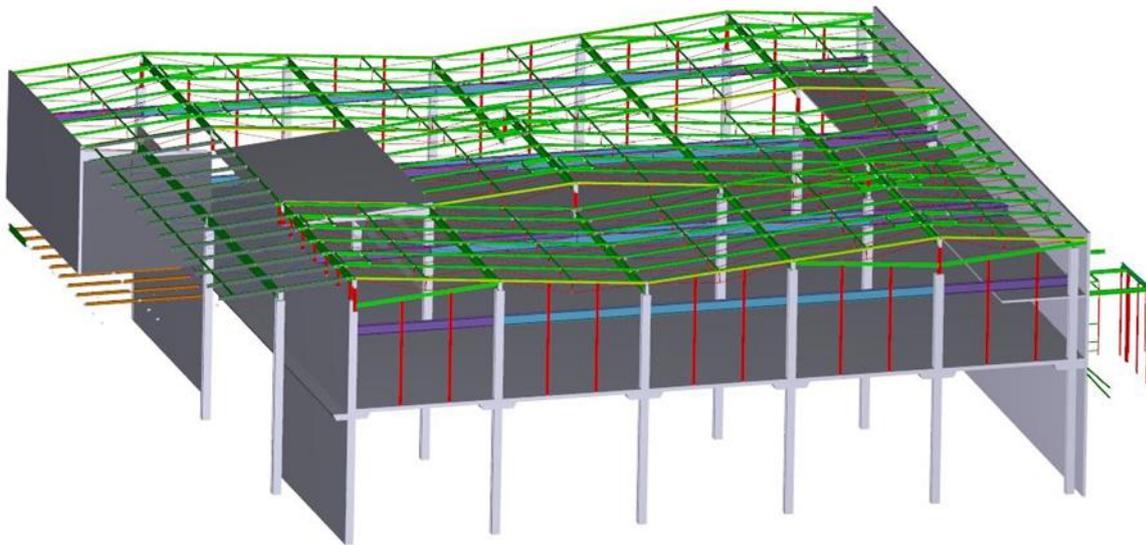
Dachkonstruktion auf Stahlbetonstützen
